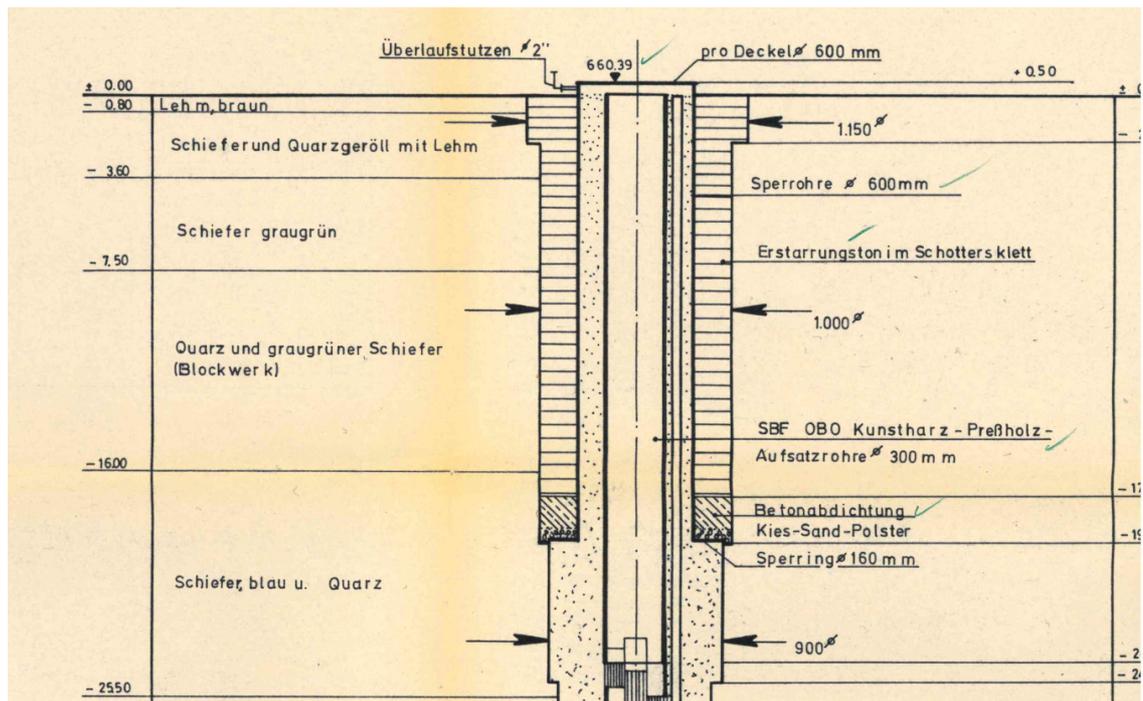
oberflächennaher Ausschnitt aus dem Brunnenausbauplan
